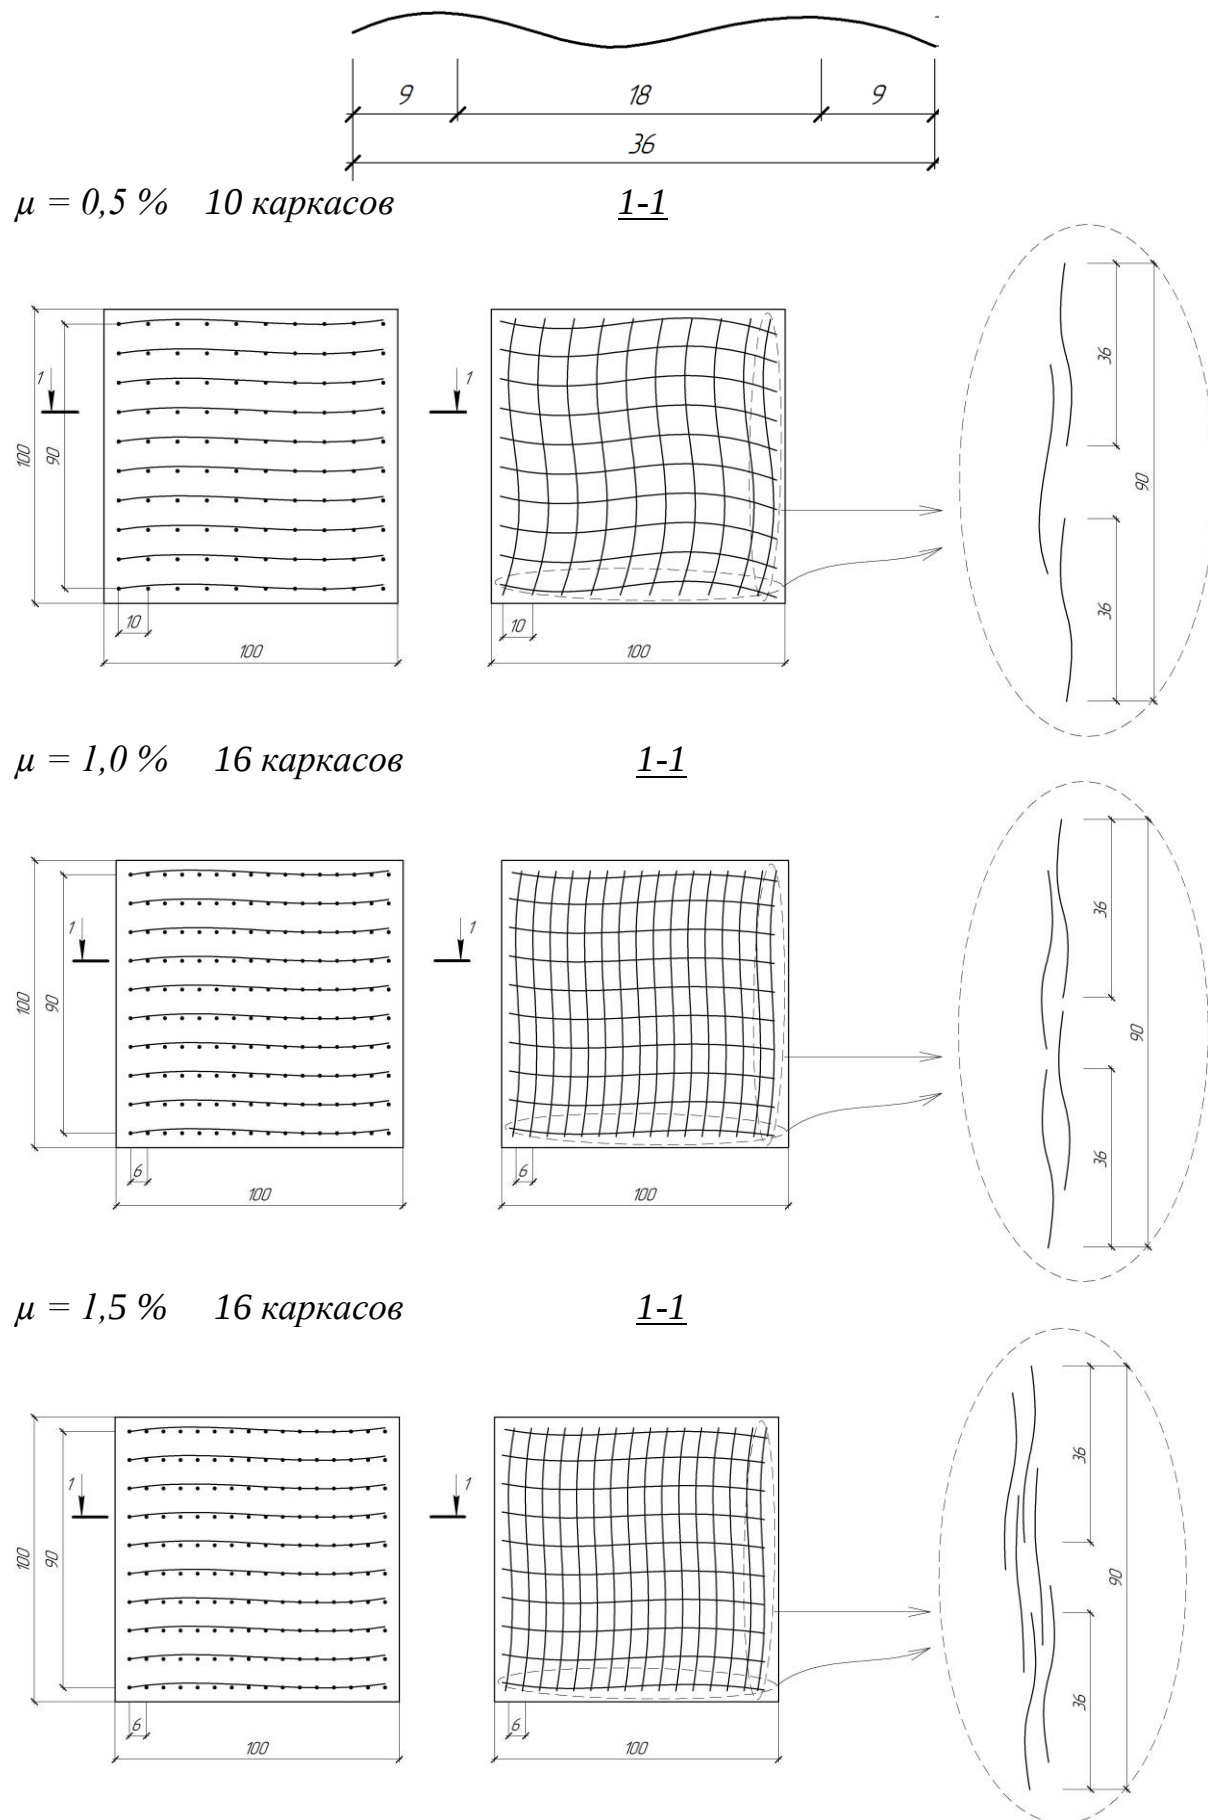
Армирование сжатых элементов сетками из листовой фибры
